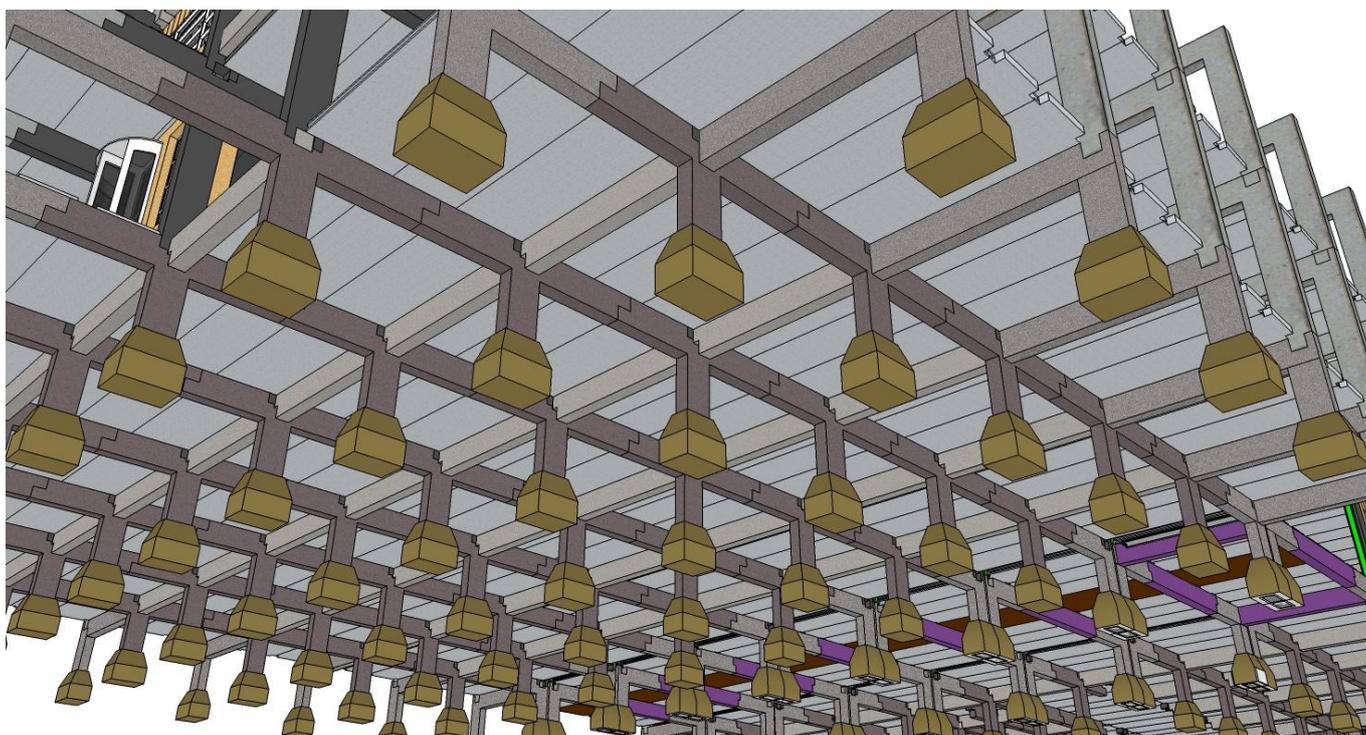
Exemple d'assemblage semelle – amorce- poteau en beton
